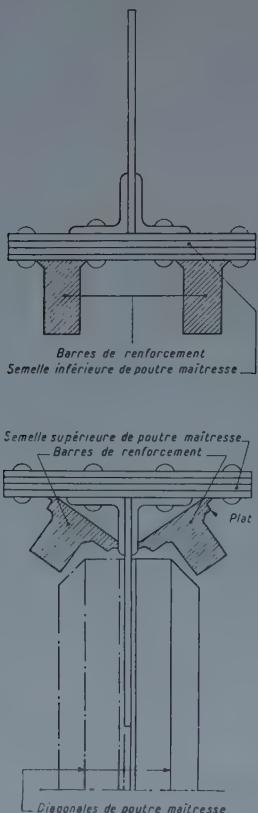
Schéma du renforcement des membrures supérieures des poutres maîtresses.
